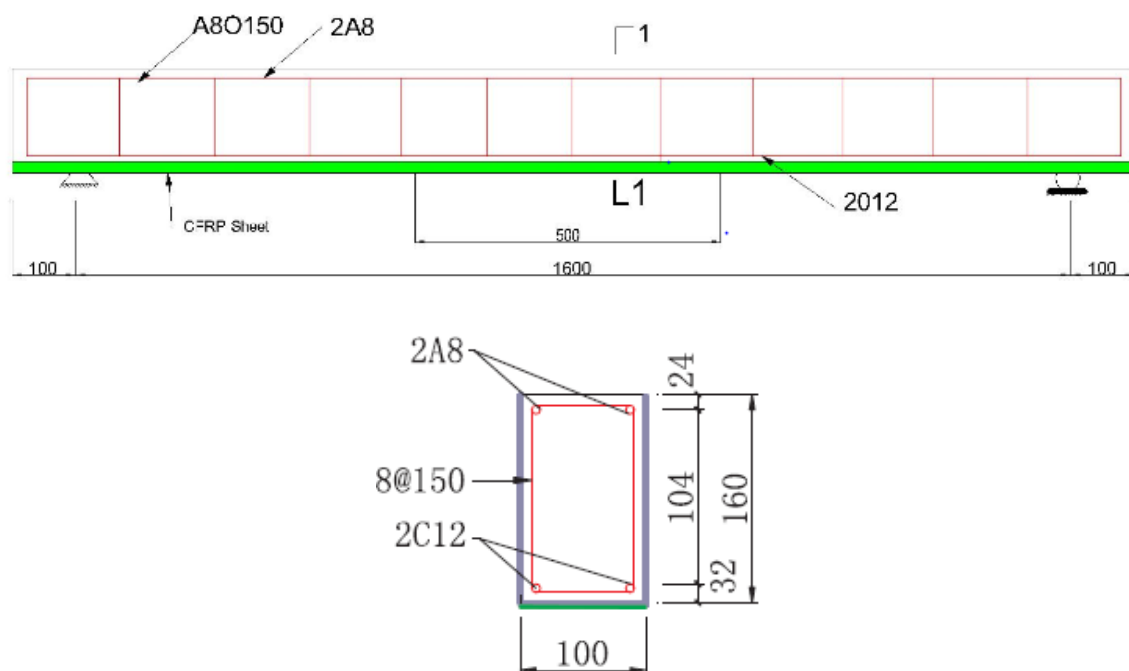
Ferrailage et dimension de la poutre expérimentée par L. Huang et al [56]
